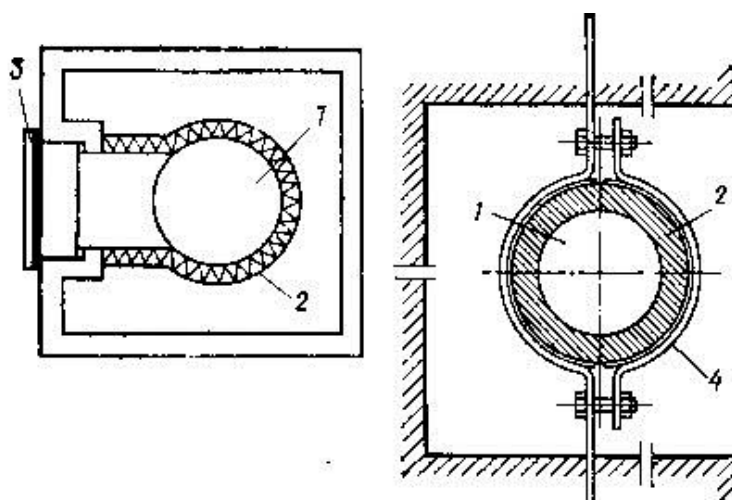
Схема звукоизоляции мусоропровода в жилом здании 1 – мусоропровод; 2 – минераловатный защитный слой; 3 – виброизолирующие прокладки; 4 – закрепление мусоропровода
